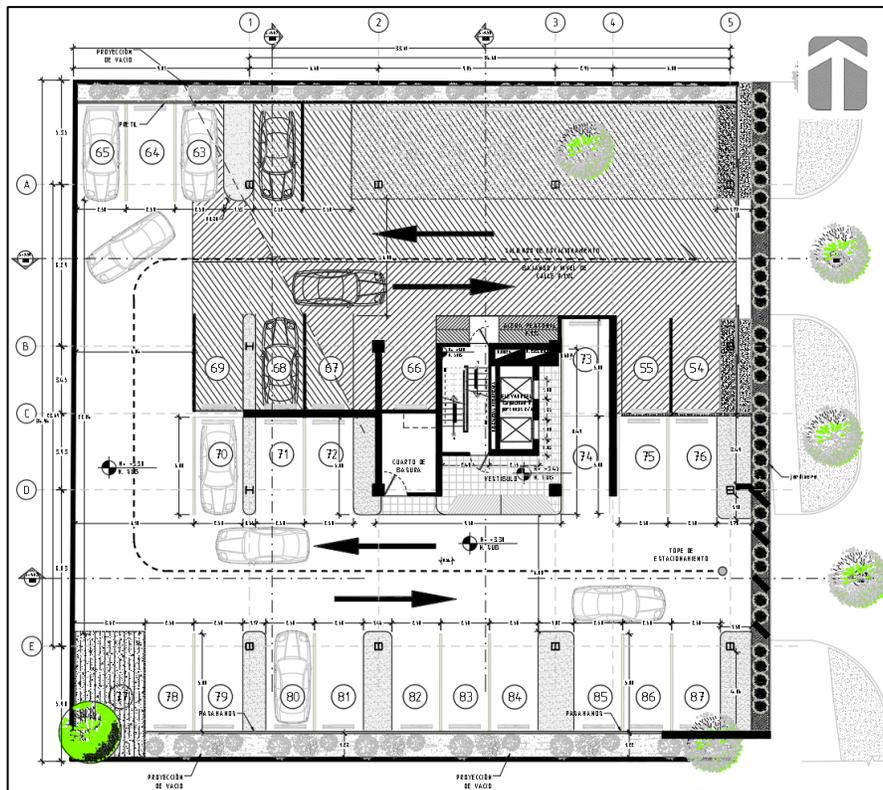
PLANTA 2DO NIVEL DE ESTACIONAMIENTO. FUENTE: MR ARQUITECTURA CONCEPTO
